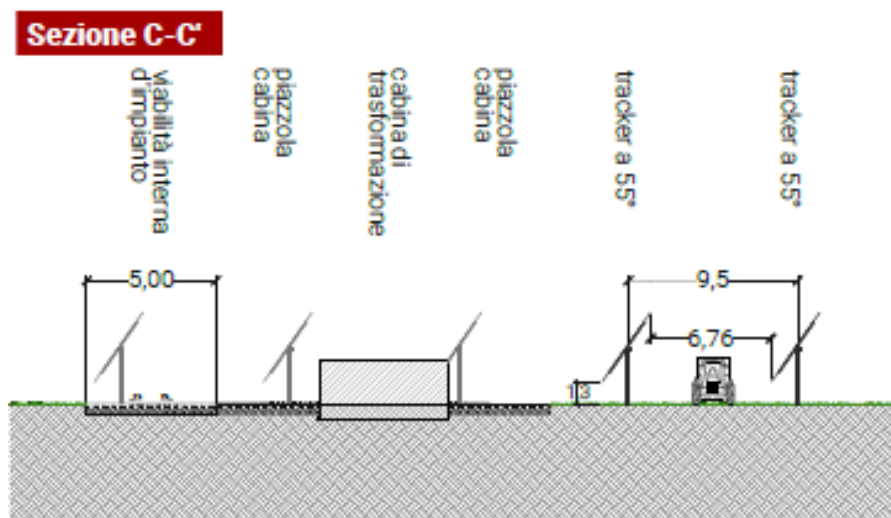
STRALCIO DI SEZIONE CON STRUTTURA E INSERIMENTO MEZZO MECCANICO
